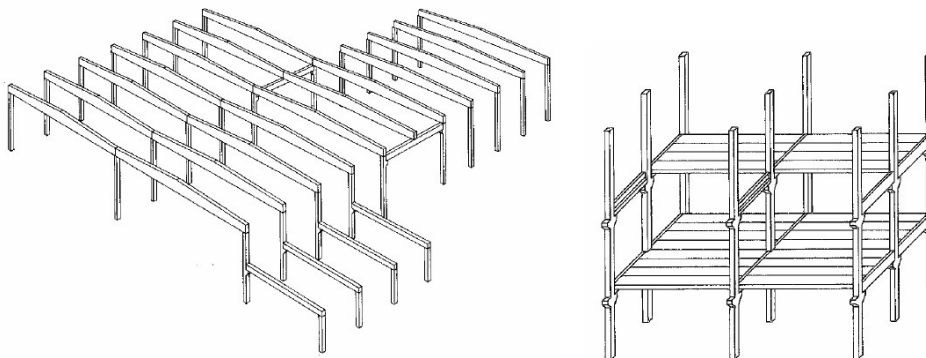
Sistema de esqueleto com pavimento único e com múltiplos pavimentos (Acker, 2008)
